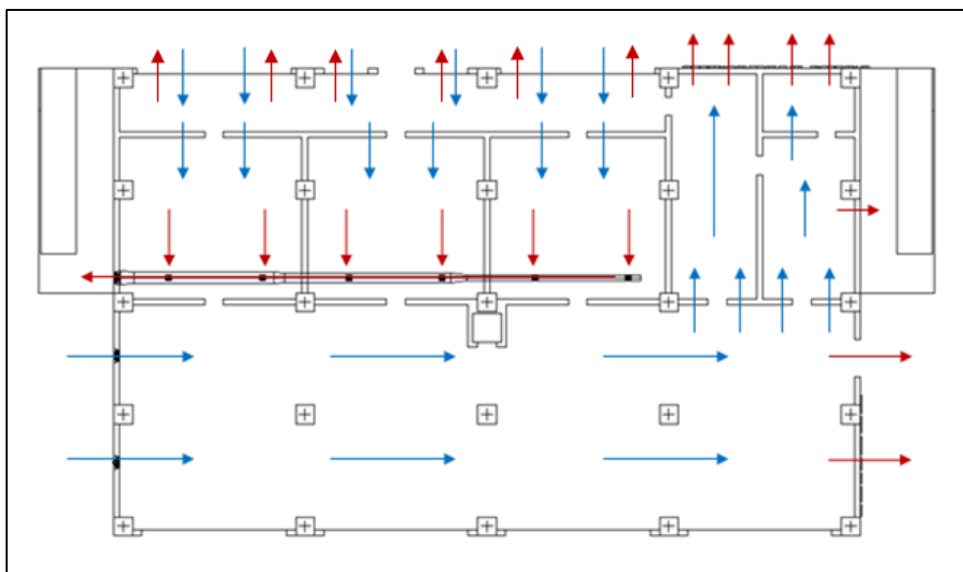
Esquema circulación de aire por planta baja. Detalles en rojo y azul, para la salida y entrada de aire respectivamente.
